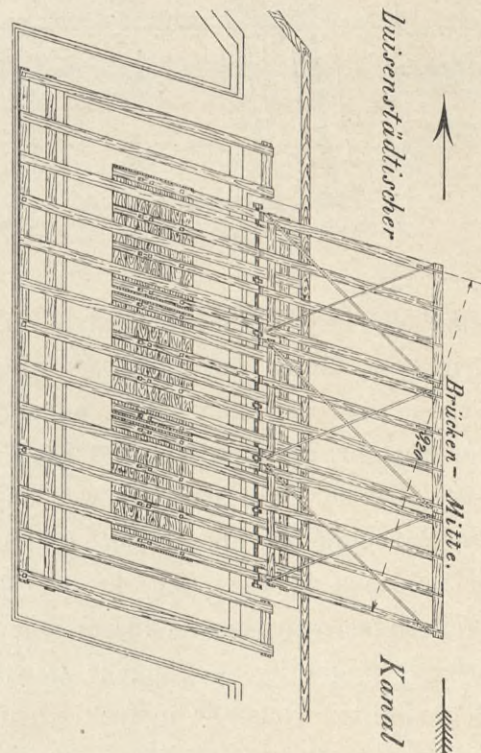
Grundriss der Adalbert-Brücke.
